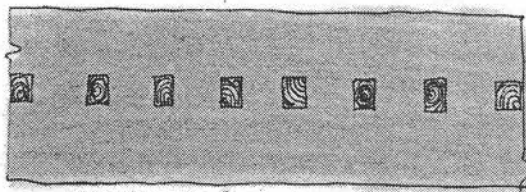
Primeiras fiadas de elevação de parede de taipa de pilão
